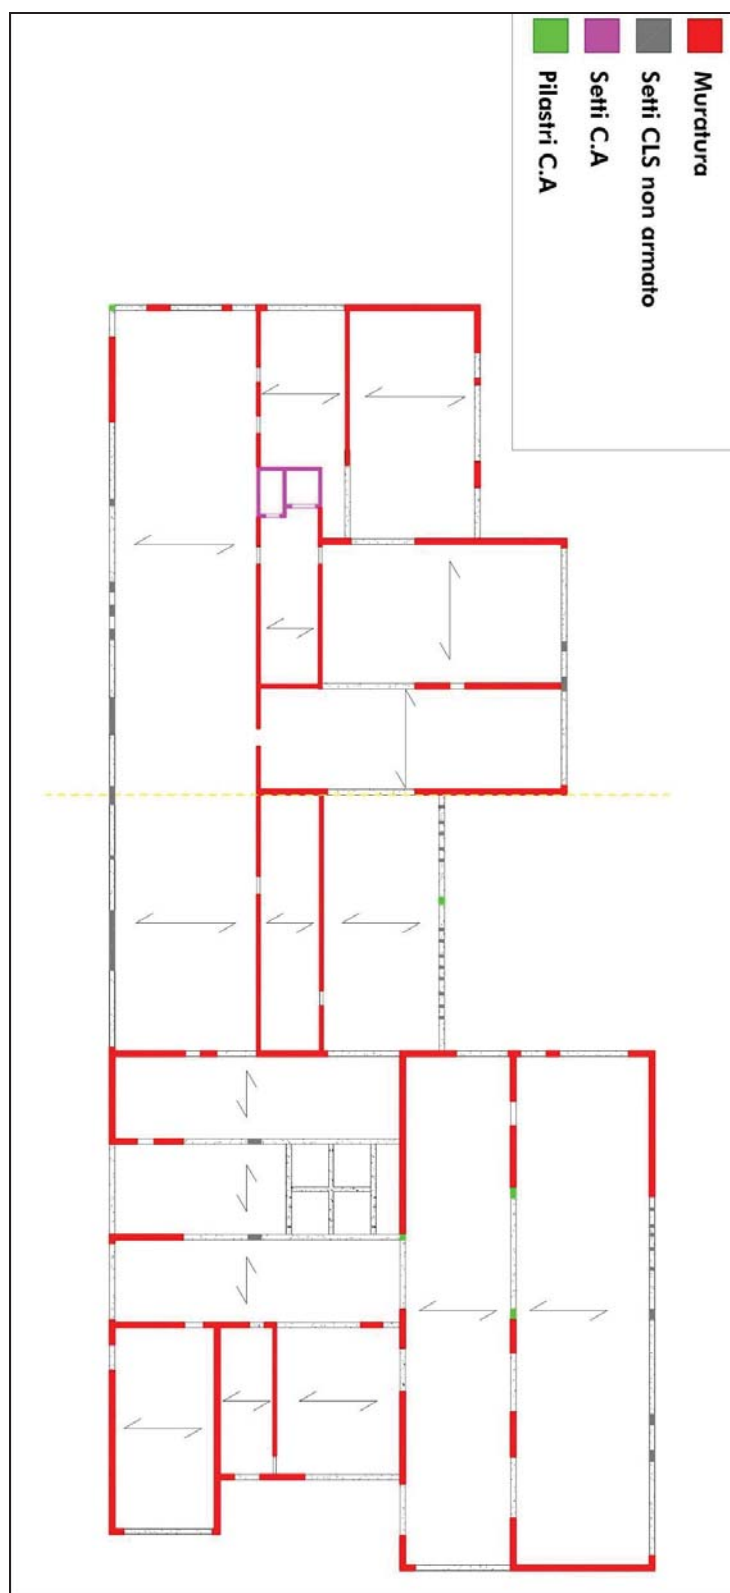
Pianta dei maschi murari, dei setti e dei pilastri del piano secondo
